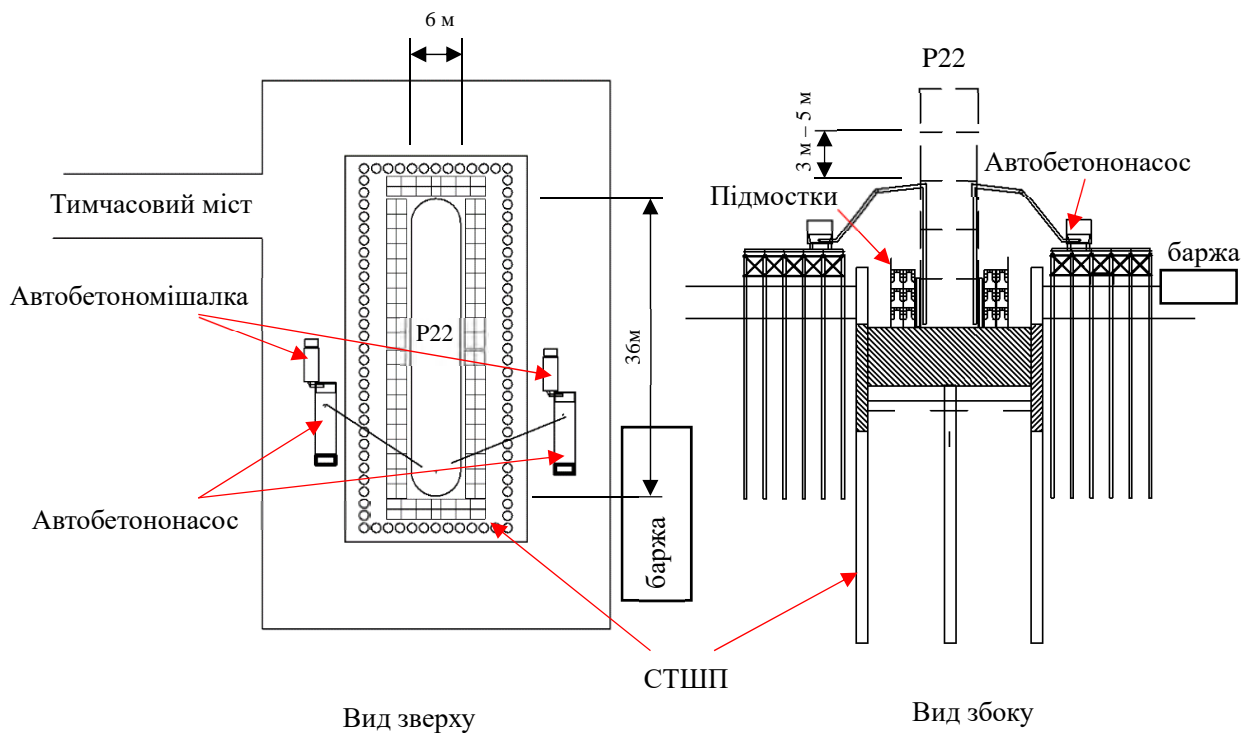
Довідкове креслення для заливання бетону опори на P22
